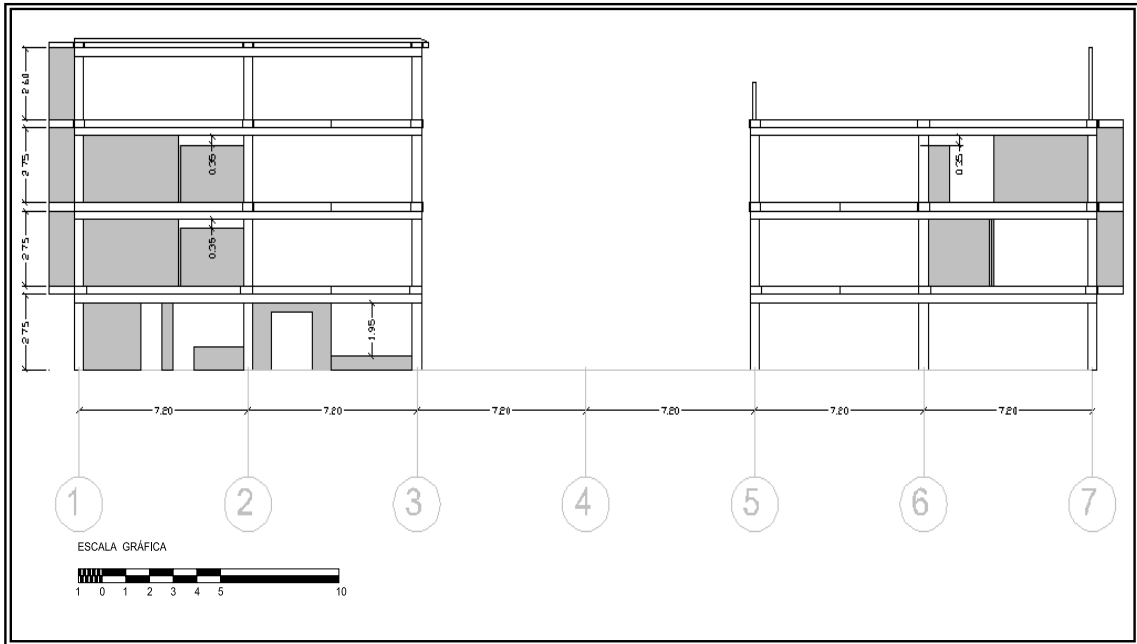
Pórtico A (este-oeste) mostrando las paredes de mampostería y la longitud efectiva de columnas
